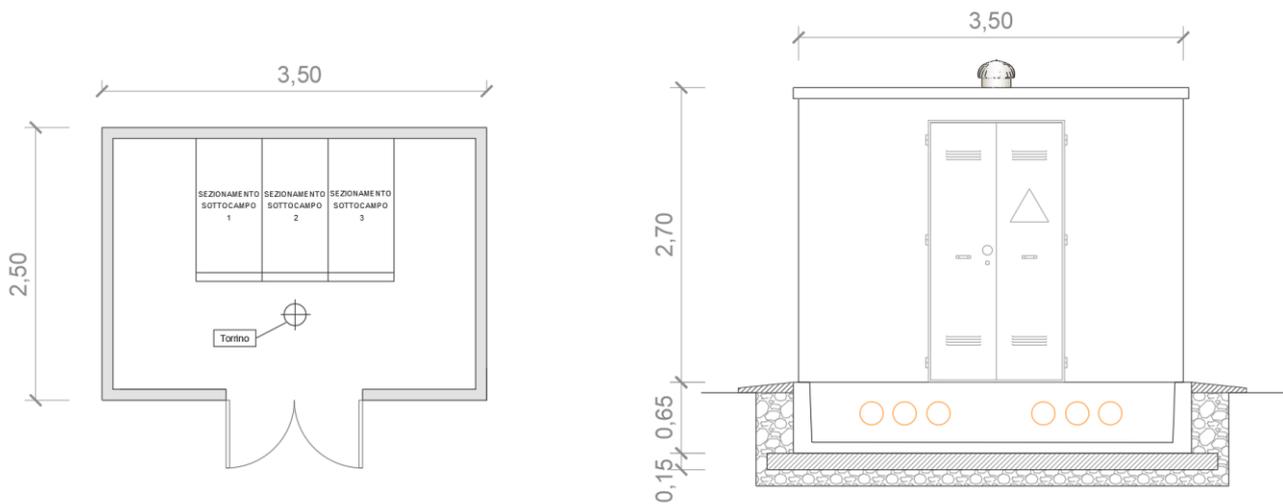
Planimetria e prospetto frontale Cabina di sezionamento
